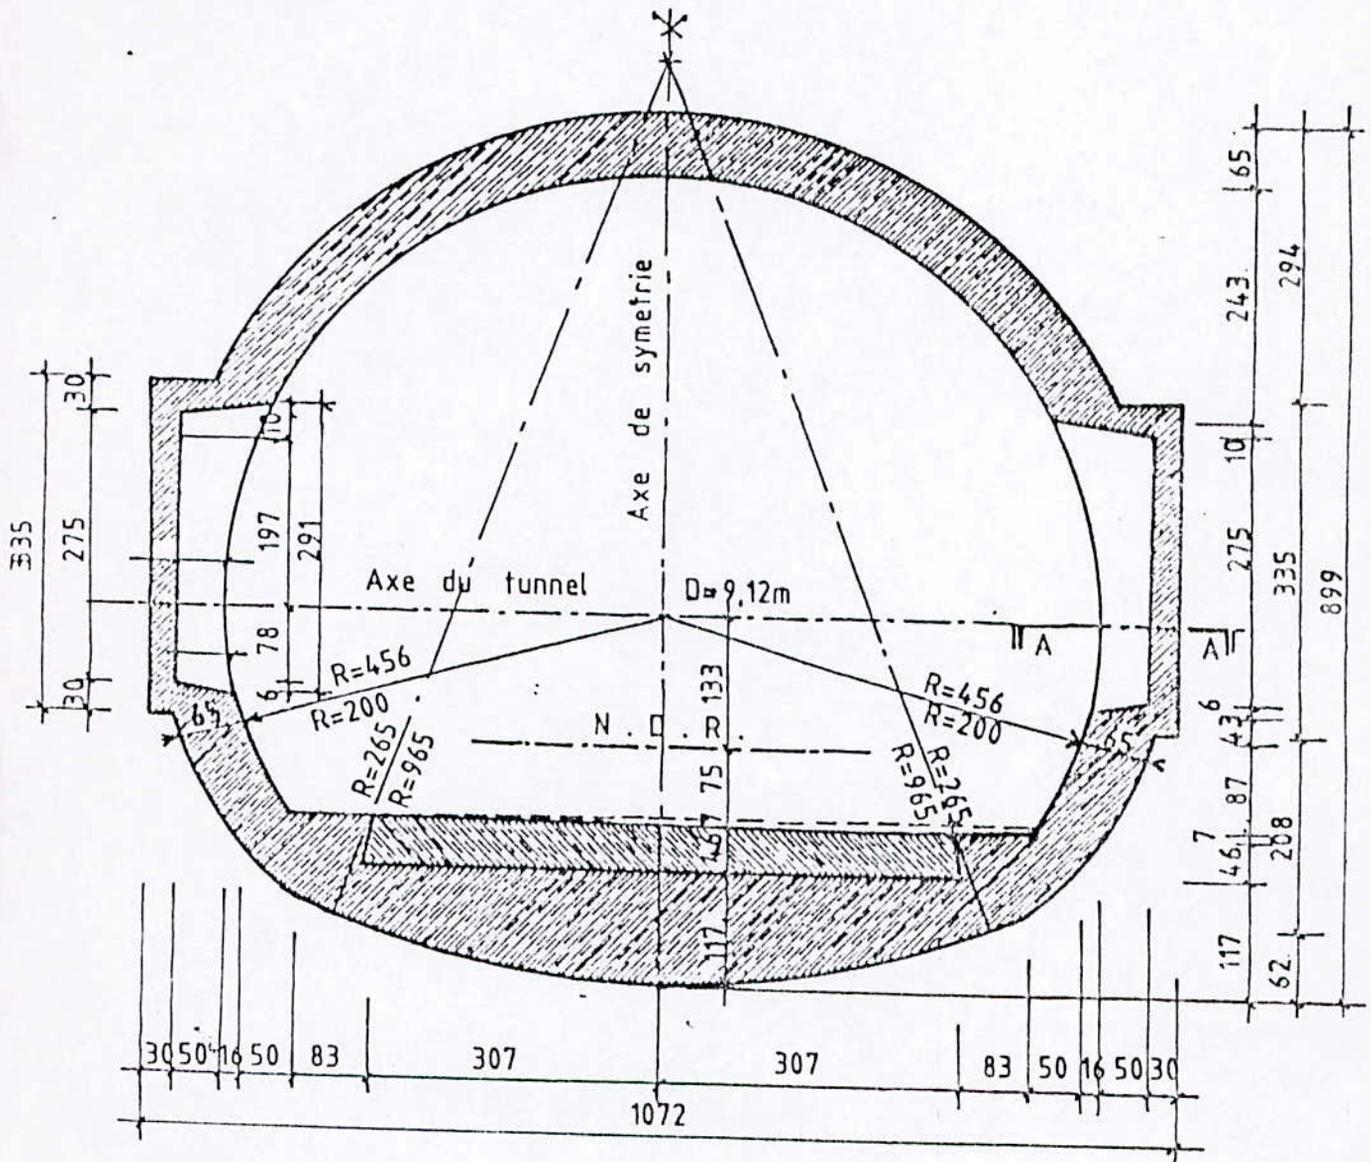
COUPE TYPE SUR LES NICHES DE SECURITE
